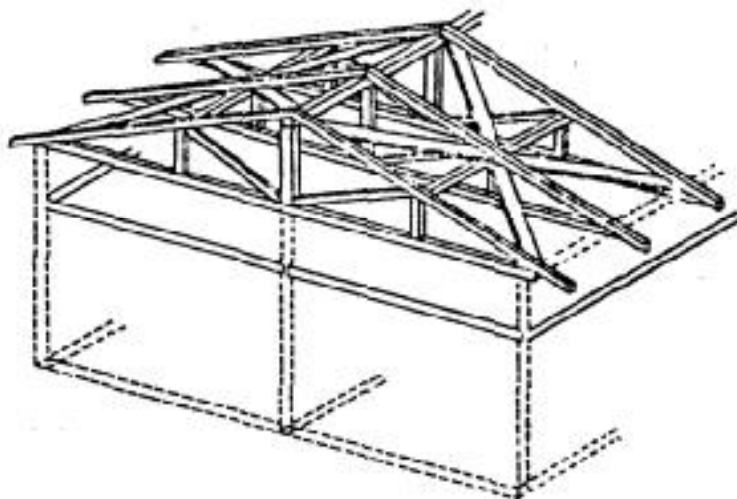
Rigidización de techos de armaduras (ref. 9)
